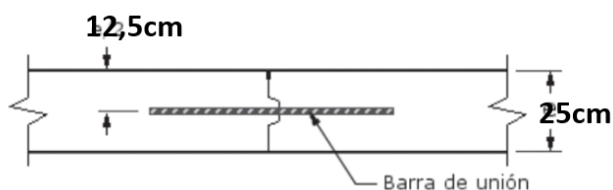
Junta longitudinal de construcción tipo D. Fuente: elaboración propia.
